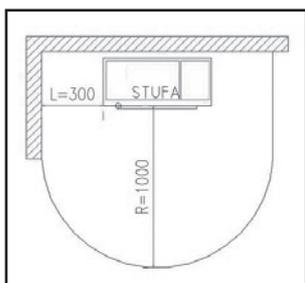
B: Distanza di sicurezza intorno alla stufa in caso di montaggio a parete
